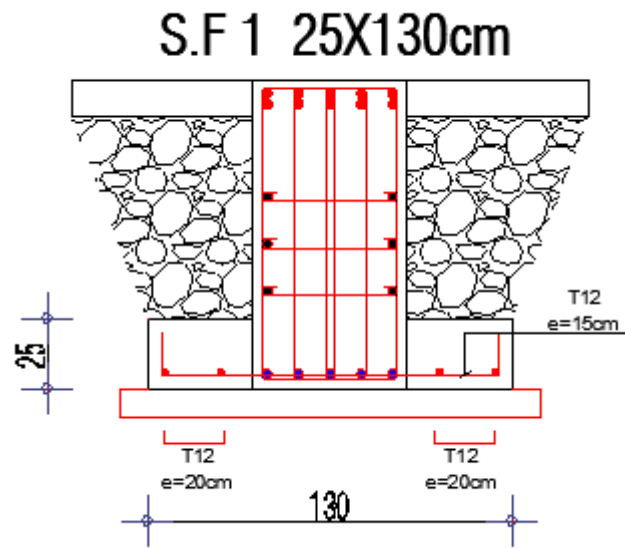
Schéma de ferrailage semelle filent 25X130
